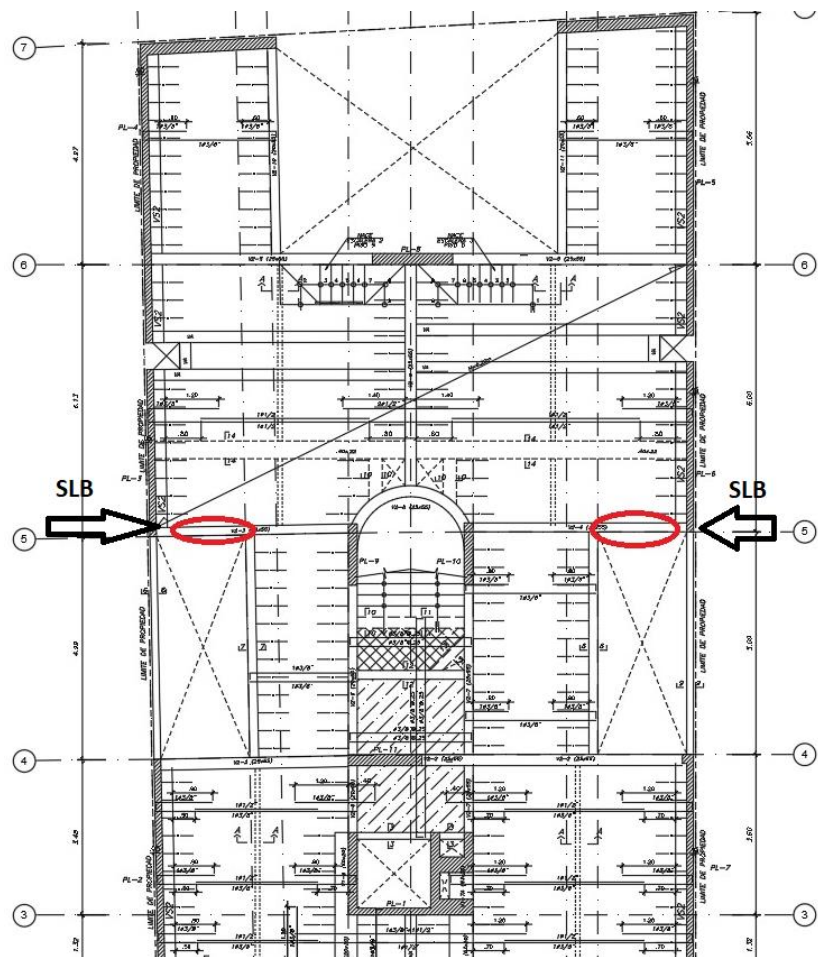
Ubicación de pórtico en planta estructural zona de estacionamiento
